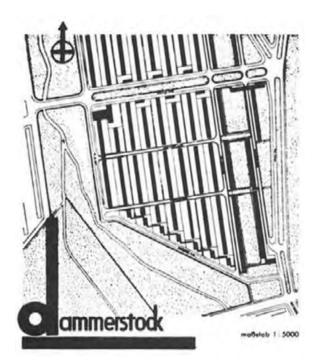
Dammerstock, plan urbano desarrollado por Gropius y Heasler en 1929 (es.wikiarouitectura.com/edificio/colonia-dammerstock/).
